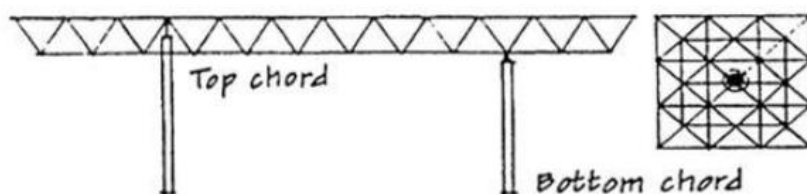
Bantalan penopang Space Frame type elastomeric pad
